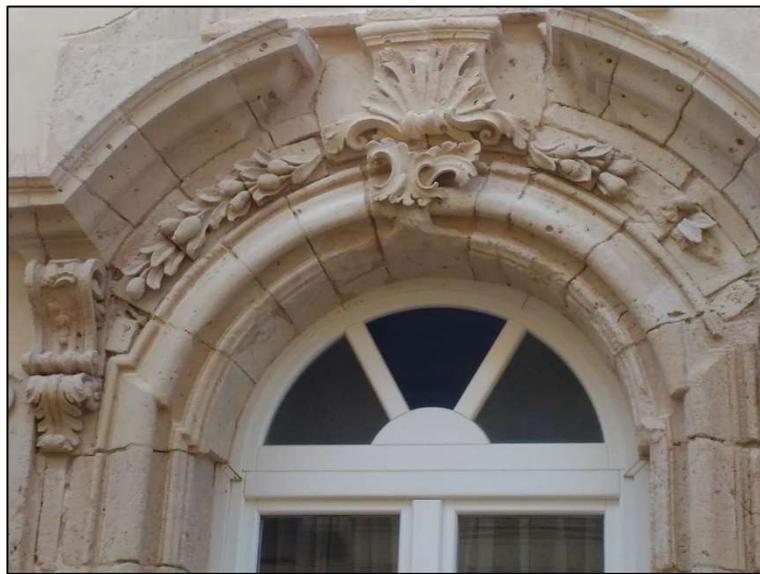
Particolare della trabeazione e dell'elemento centrale (foto dell'autore)
